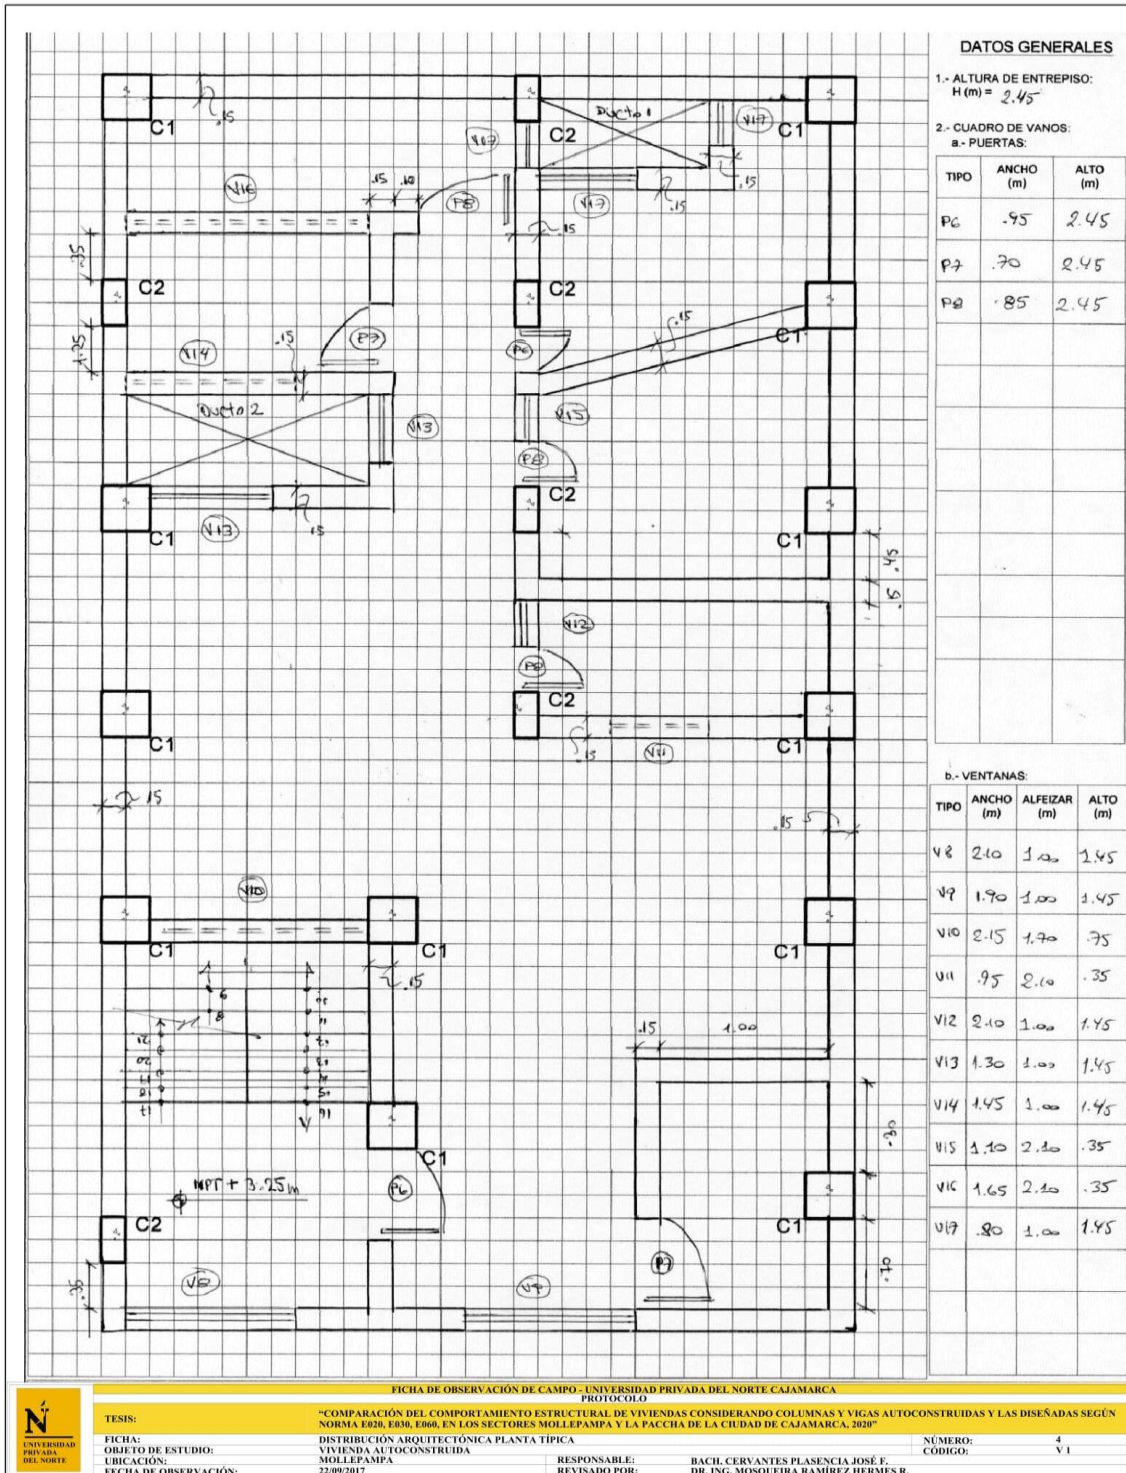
Ficha arquitectura 2º planta vivienda 1.
